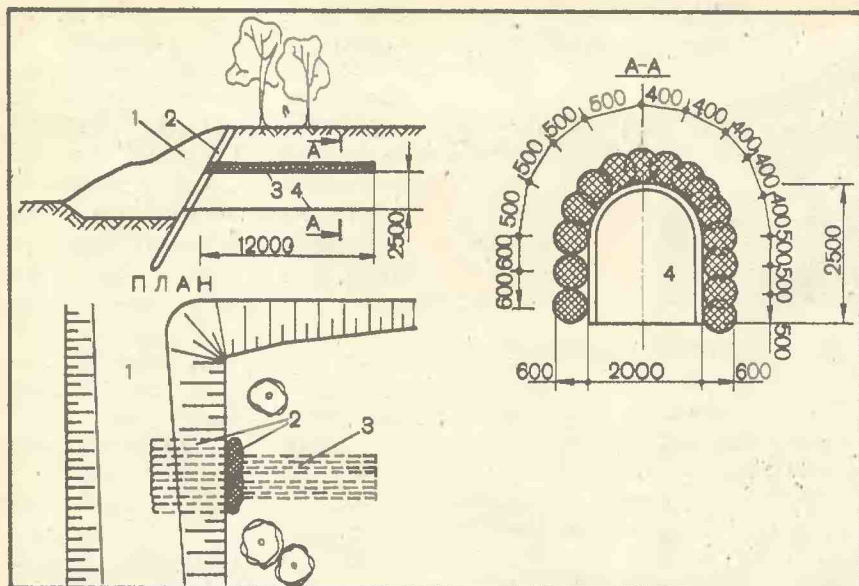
Схема закрепления грунта на припортальном участке тоннеля: 1 — предпортальная выемка; 2 — наклонная крепь; 3 — опережающая крепь; 4 — тоннель.
